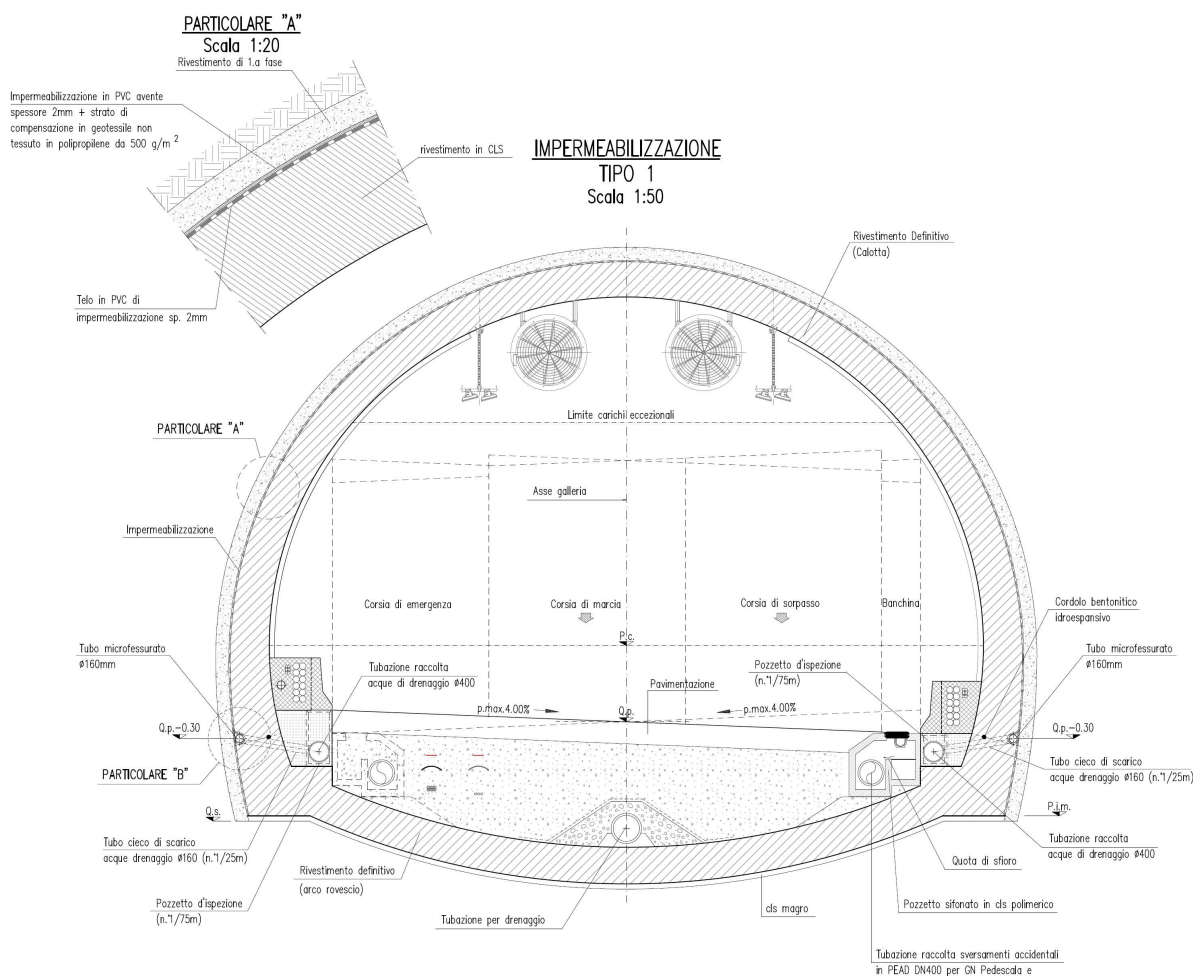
Impermeabilizzazione e drenaggio TIPO 1
